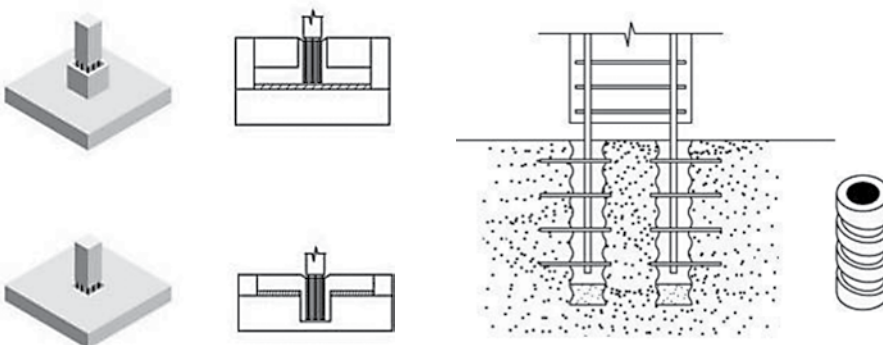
Encuentros pilar-fundación, con barras grouteadas en vainas embebidas en fundación.
